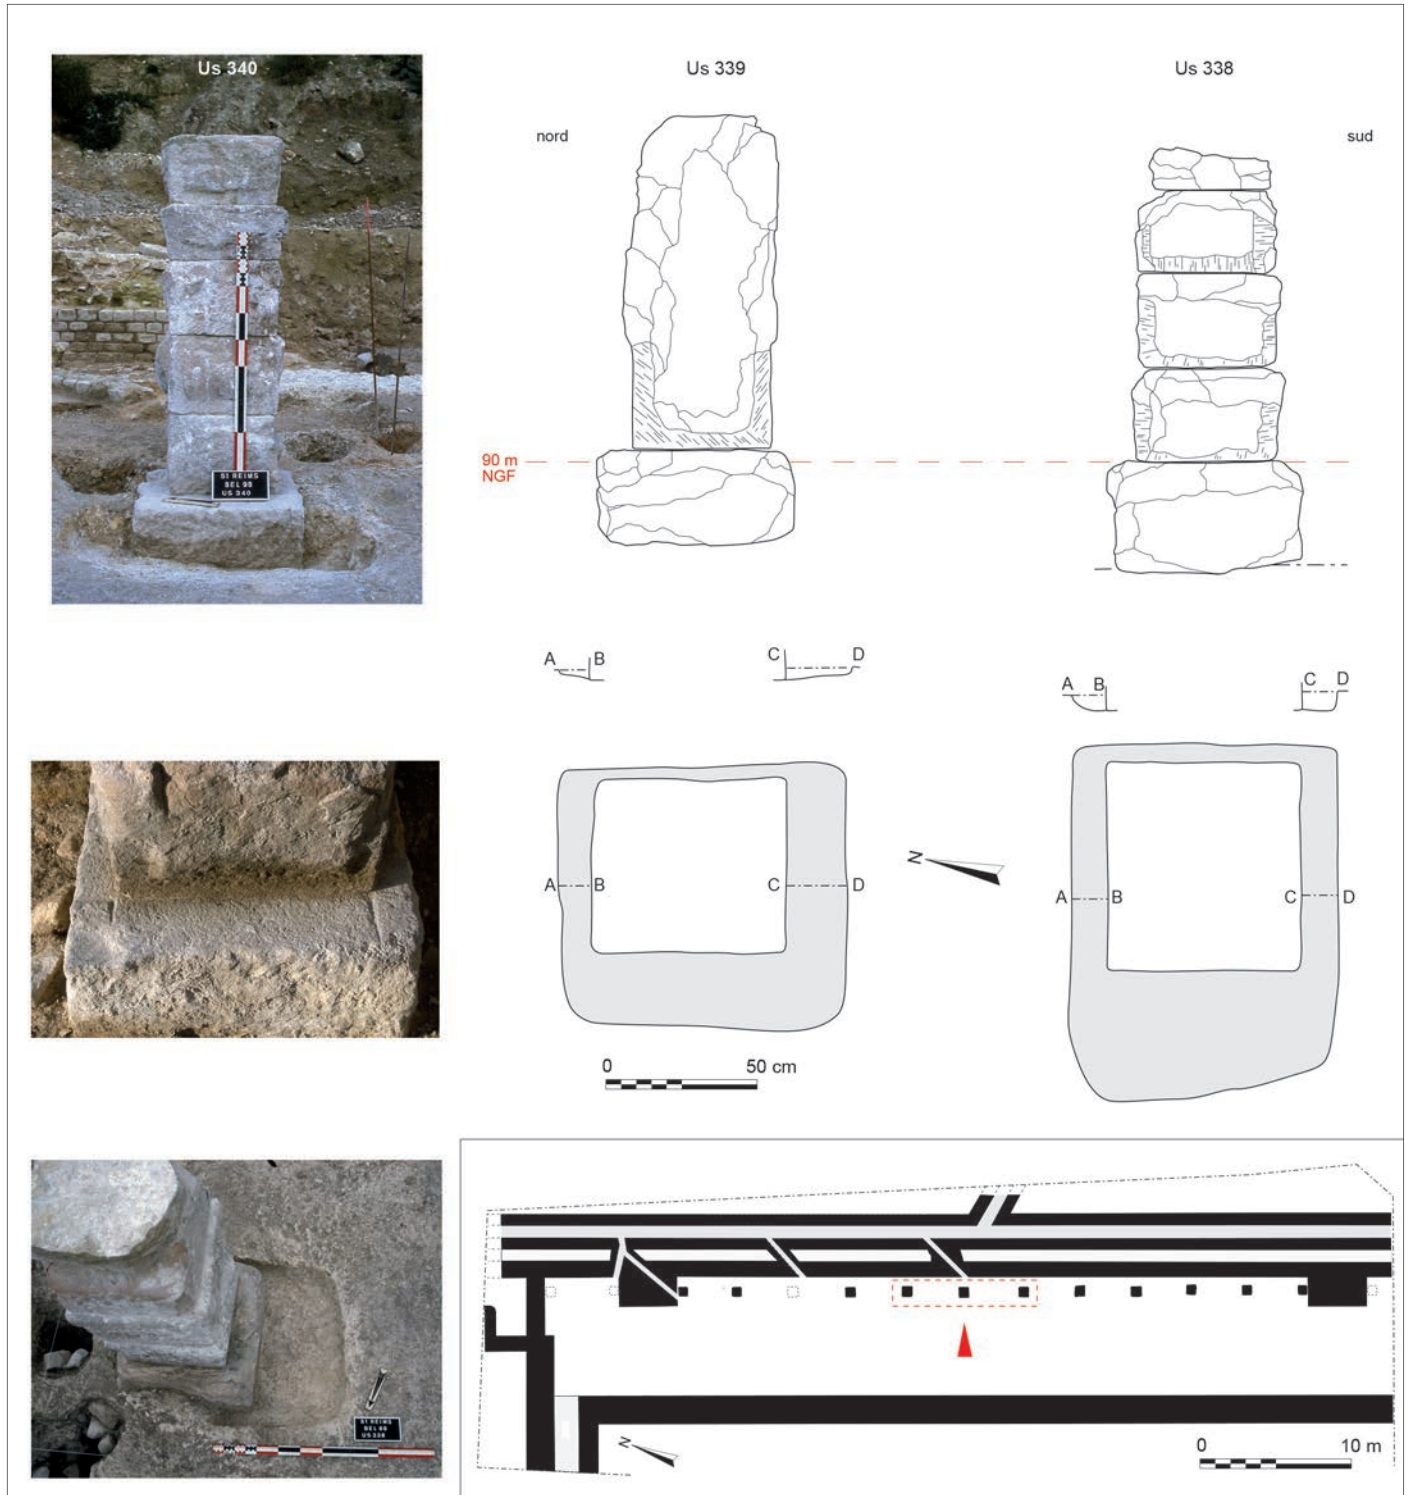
Plans et vue des élévations conservées de trois des piliers de la grande salle depuis l’ouest (en haut) ; plans et vue des bases et fondations de ces mêmes piliers (en bas) (DAO : F. Moiret, É. Jouhet ; clichés : P. Rollet).
